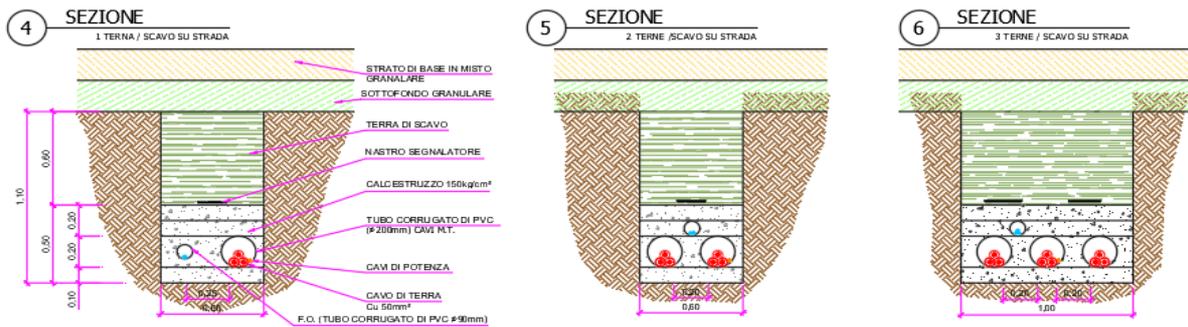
Sezione tipo di scavo su viabilità con o senza pavimentazione
